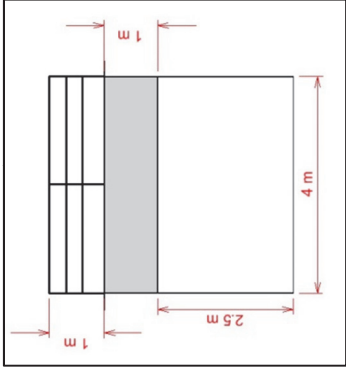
Estructura M13, culvert accés institut, sobre la riera Gavarrà
